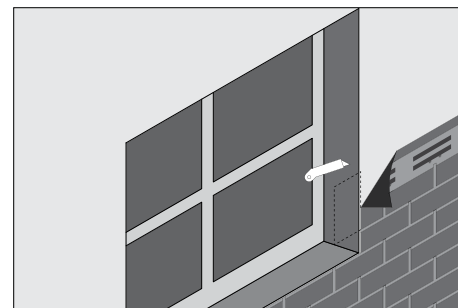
Монтаж фасадной плитки вокруг оконных проемов
